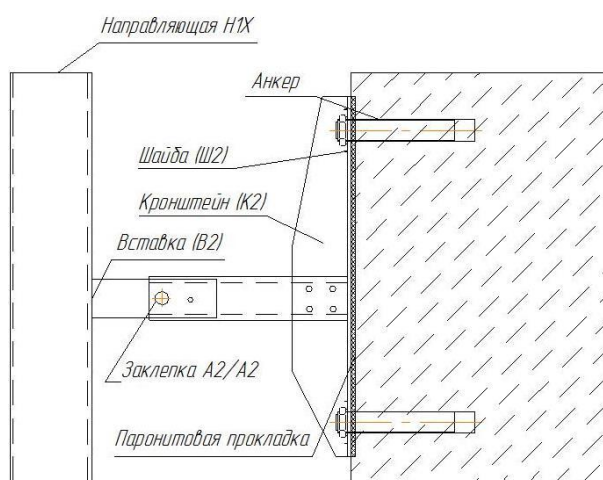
Установка профиля металлокаркаса (вид сбоку)
